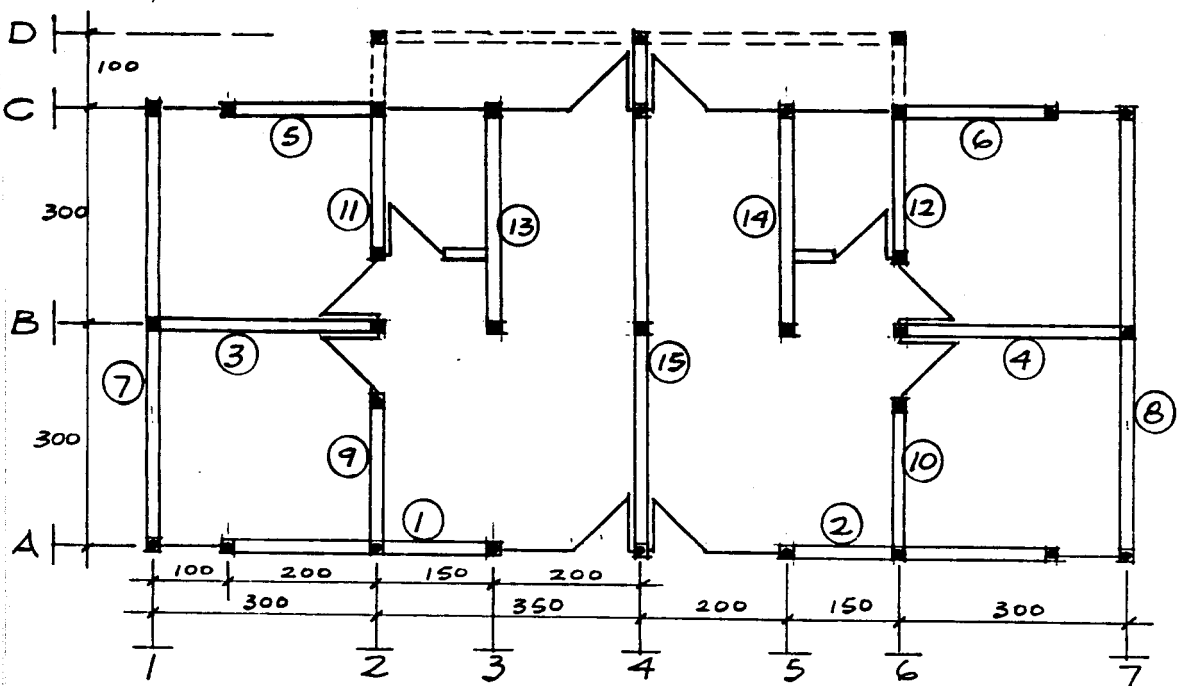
A) PLANTA de LOCALIZACION de MUROS
